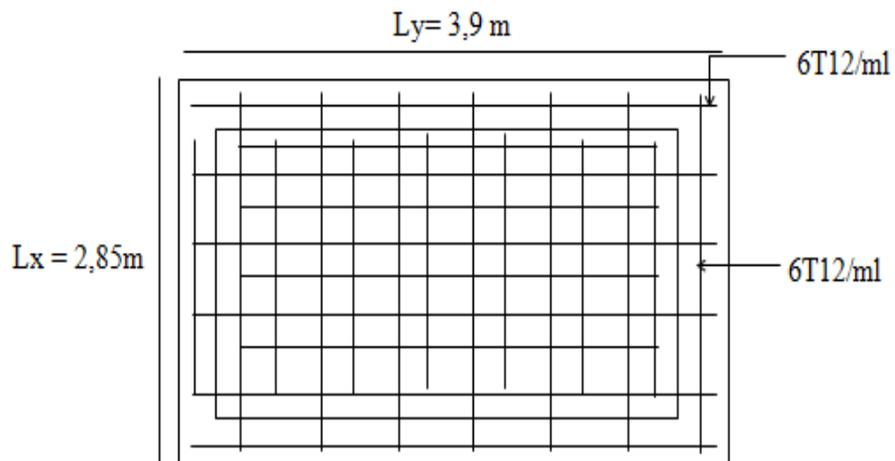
Dessin Ferrailage inferieur du panneau de la dalle pleine.
